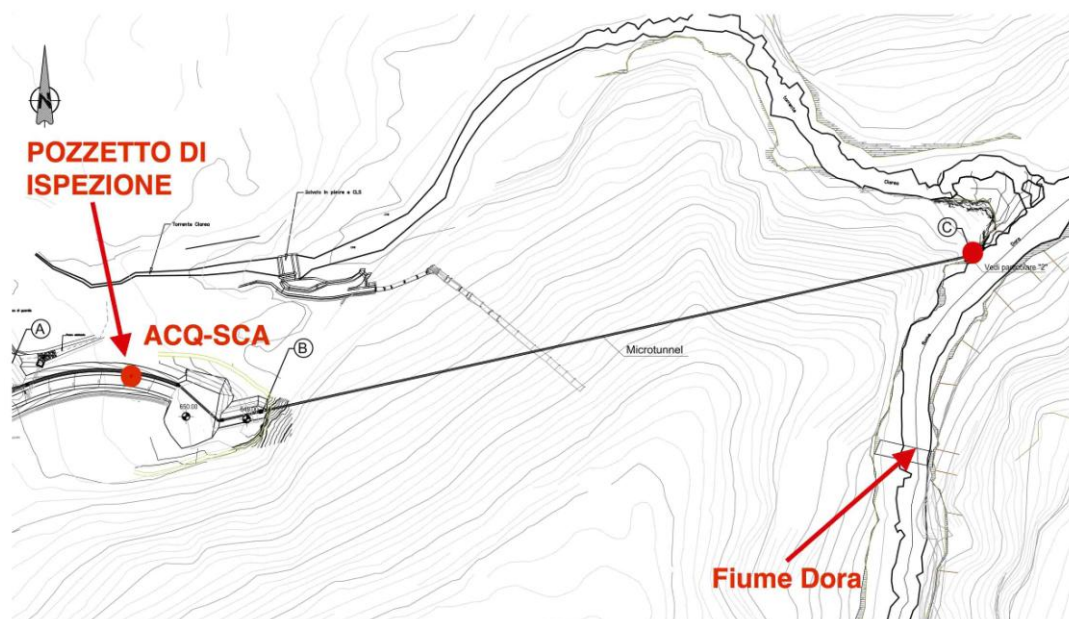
localizzazione del punto di scarico rispetto all'area di cantiere
